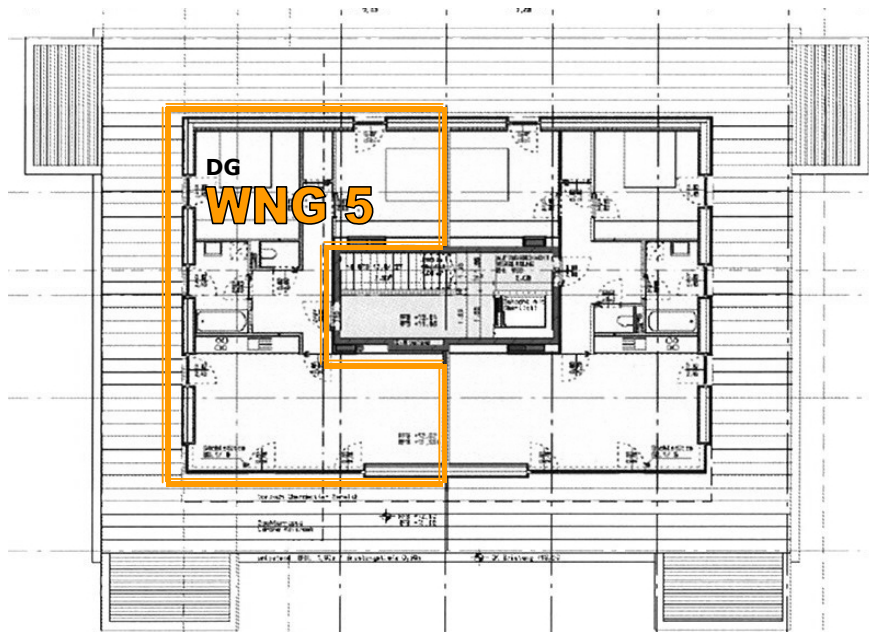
Grundriss viertes Obergeschoss mit Lage der fünften Messwohnung
